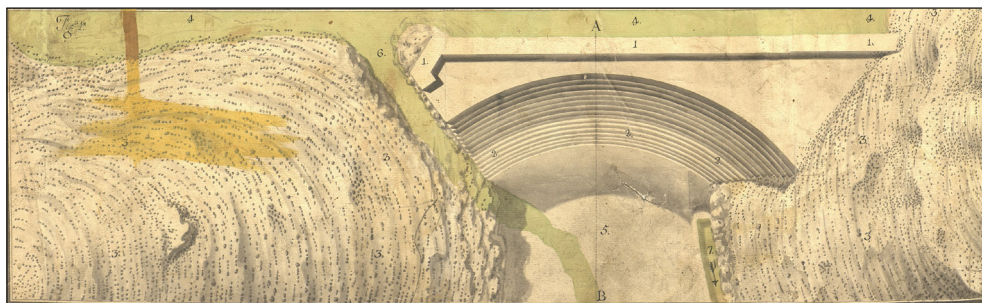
Planta del pantano con el estado previo a la construcción del recrecimiento (sección 7 del plano).
